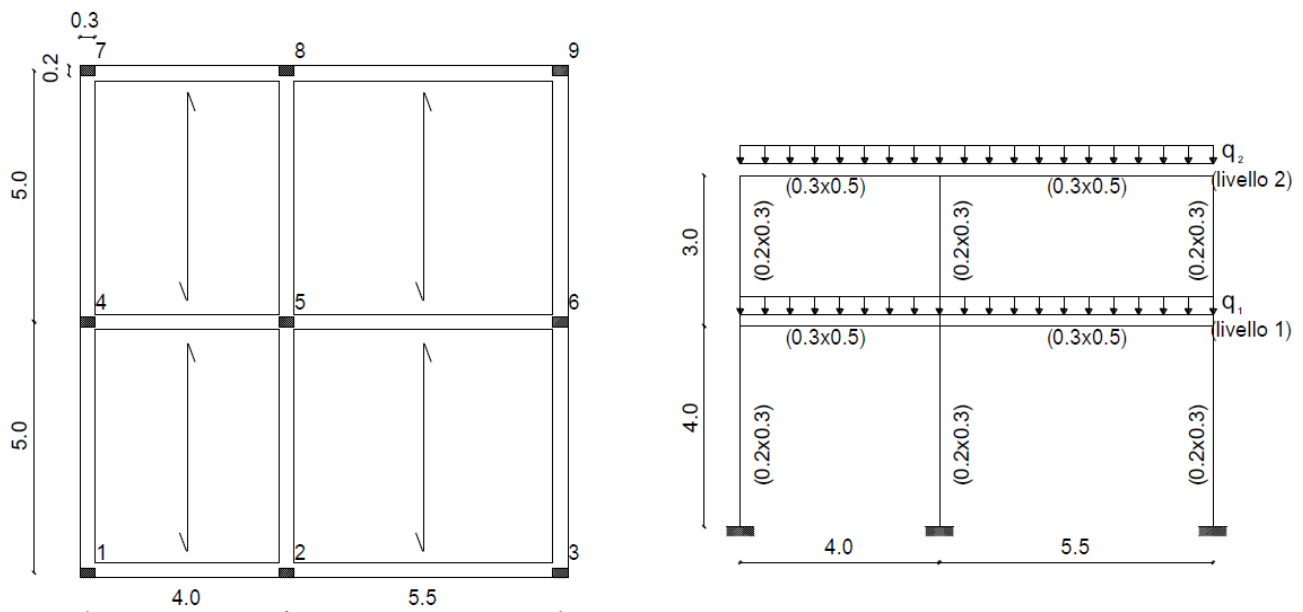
Geometria della struttura di c.a. (dimensioni in m).
